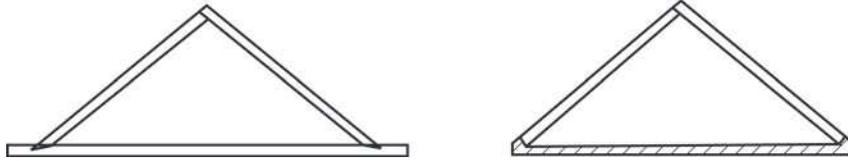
Prinzip des Sparrendaches: a) in Verbindung mit einer Holzbalkendecke
